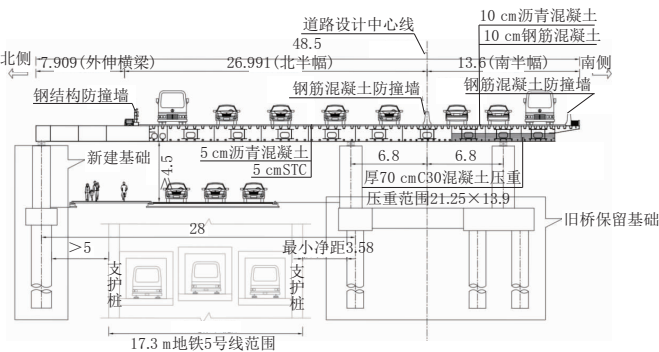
黄埔大道支线第三联钢箱梁横断面布置图 A-A(单位:m)
